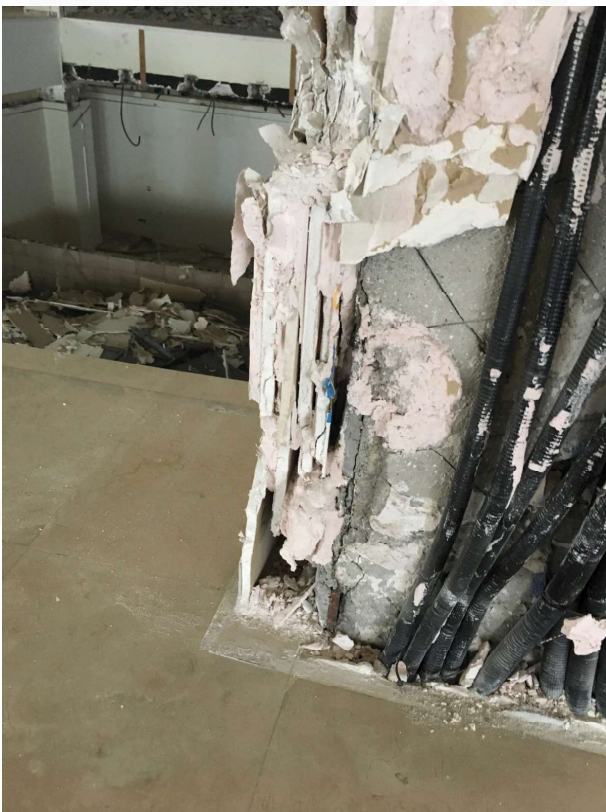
\_Spalling del recubrimiento mecánico de las armaduras de acero en forjado.
